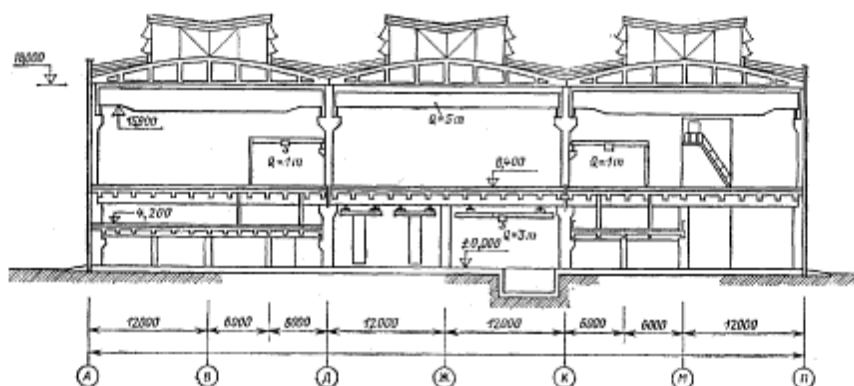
Разрез двухэтажного литейного цеха, выполненного из сборного железобетона. Пол второго этажа – на отметке 8400 мм. Промежуточные площадки для размещения конвейеров охлаждения отливок на отметке 4200 мм. Здание перекрыто сборными железобетонными безраскосными фермами, на кровле – светоаэрационные фонари.
